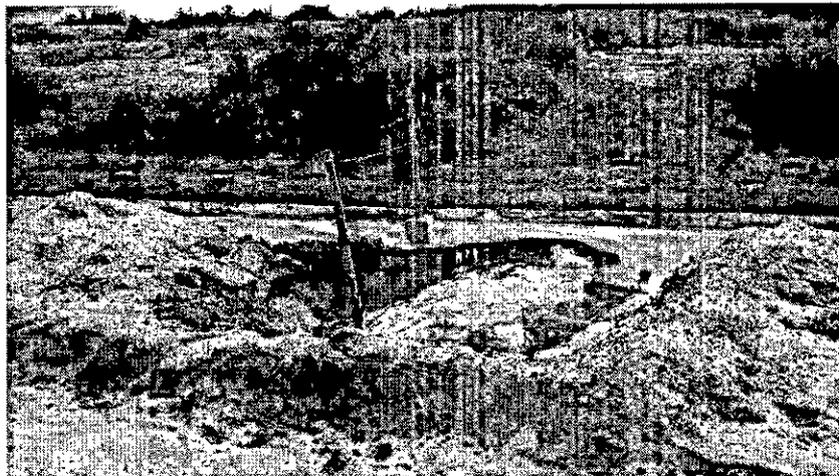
RUA C7, NECESSITANDO DE RESTAURAÇÃO.
